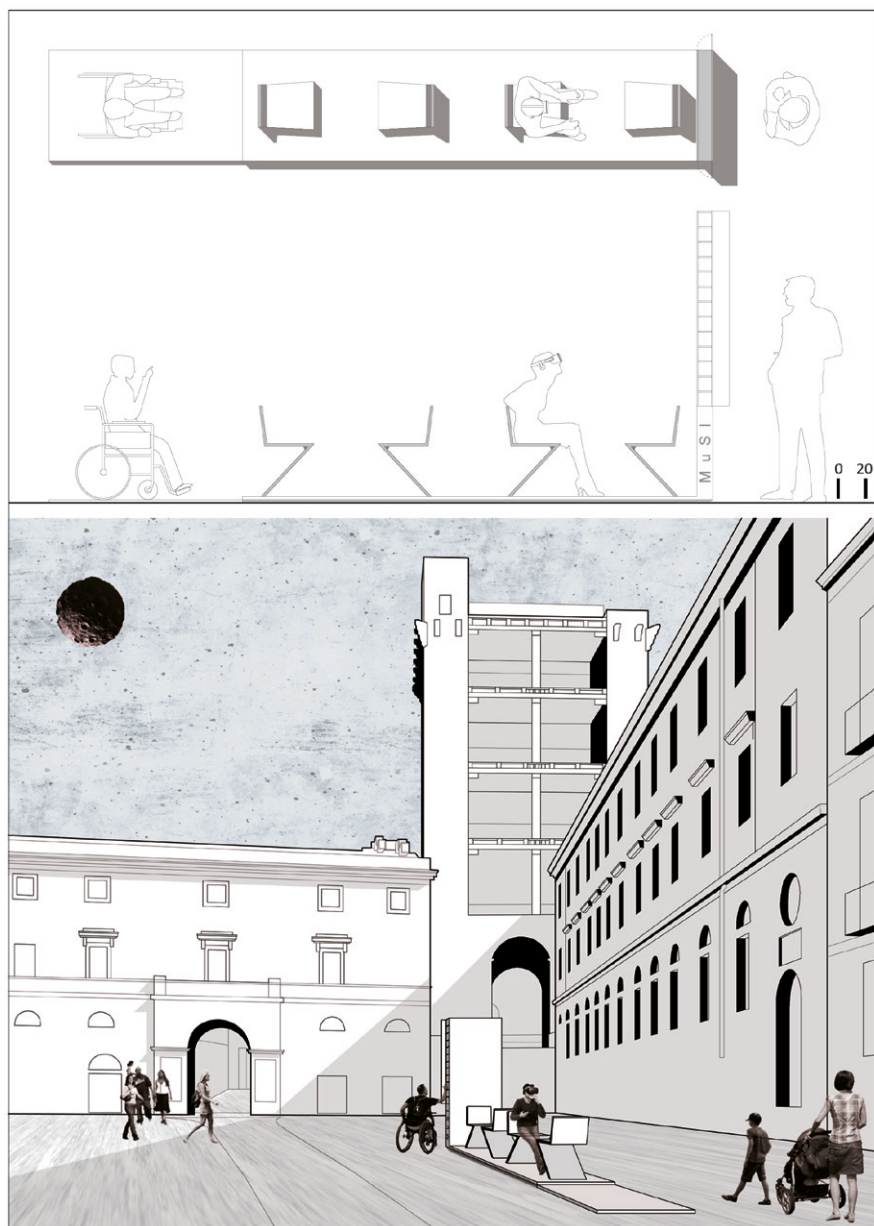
Dall'alto verso il basso: planivolumetrico e visione frontale del dispositivo architettonico appartenente al MuSI, seguiti dallo scenario prospettico di piazza Indipendenza. Il nuovo elemento urbano è orientato lungo la direzione che unisce idealmente le due torri trecentesche con il porto. L'immagine dà conto dell'inserimento nel contesto, ma anche dell'uso di tale spazio da parte di persone con disabilità. Esse, infatti, hanno la possibilità di accostarsi alla parte laterale del volume verticale per acquisire i visori VR e, successivamente, di posizionarsi lungo la parte di pedana che precede le sedute. Sulla superficie verticale di questa forma piegata sono riportate le indicazioni per una pratica dell'esperienza immersiva nel contesto storico del quartiere, secondo una lettura che favorisce tutti i tipi di utenza. *Progetto di G.B. Cocco e C. Giannattasio, in collaborazione con M. Cogoni, A. Pinna e M. Tanca; elaborazione grafica di M. Cogoni e N. Paba, 2020.
